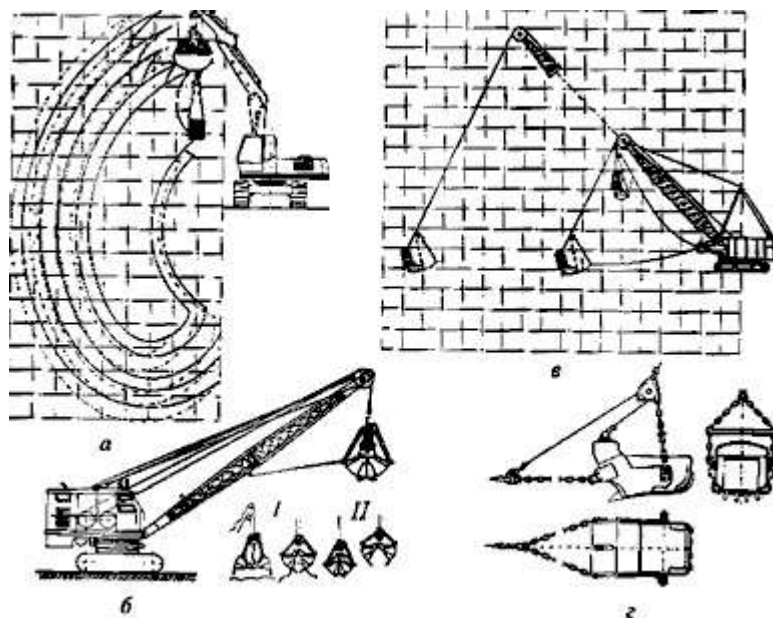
Схемы разработки грунта экскаваторами, оборудованными ковшами "грейфер" и "драглайн":
